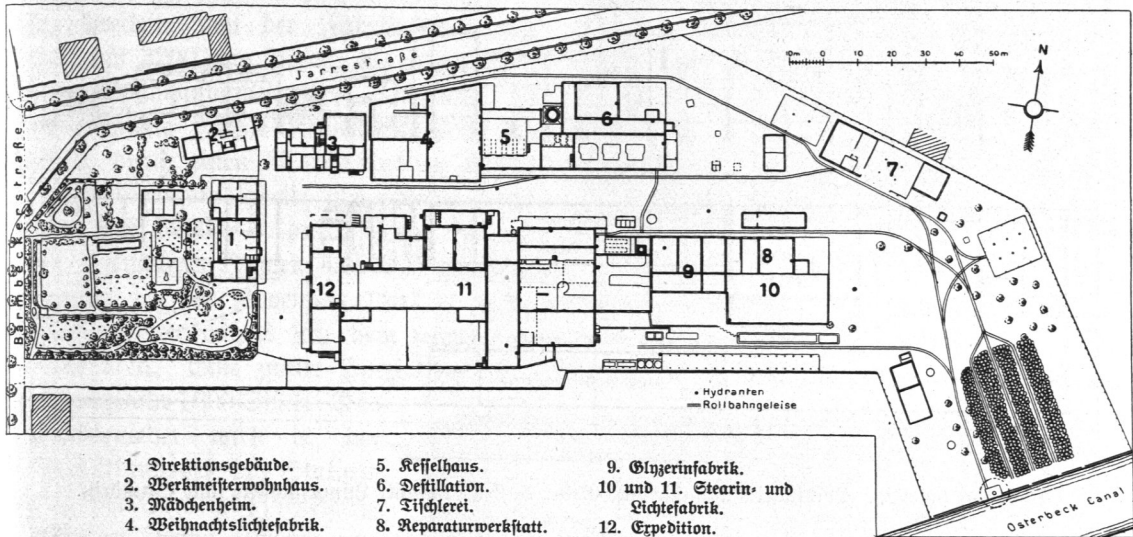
Hammonia-Stearin-Fabrik, Lageplan.
